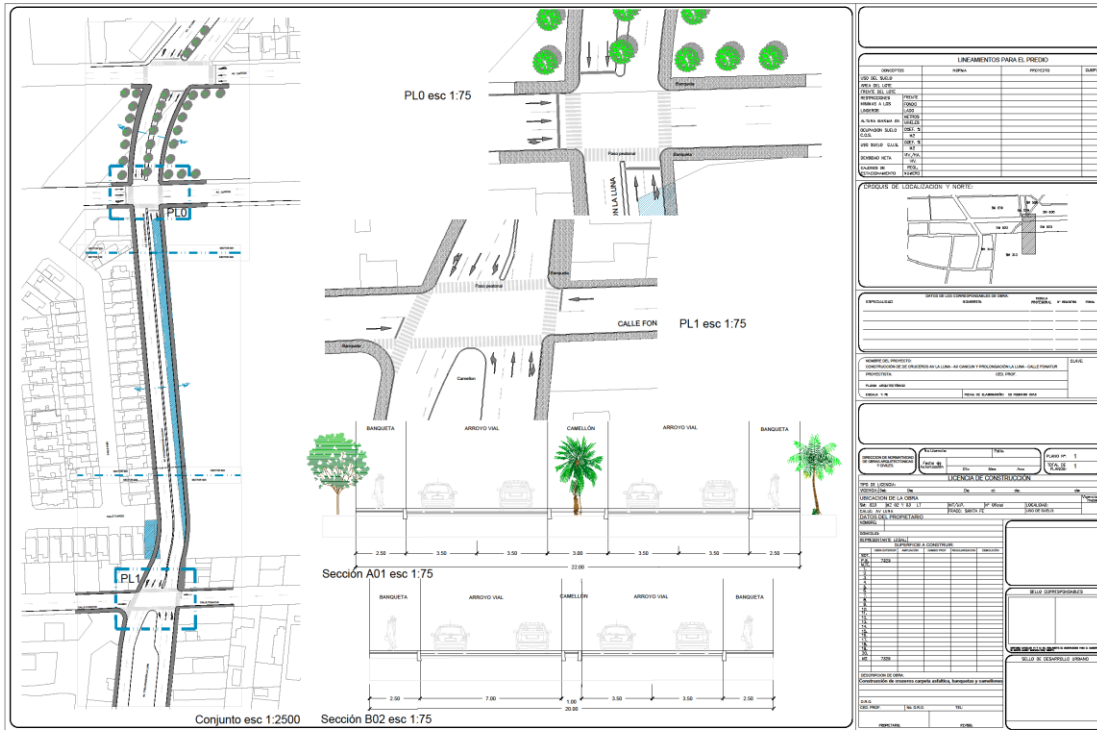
Plano del Plan Maestro del proyecto "Ampliación Av. La Luna"
